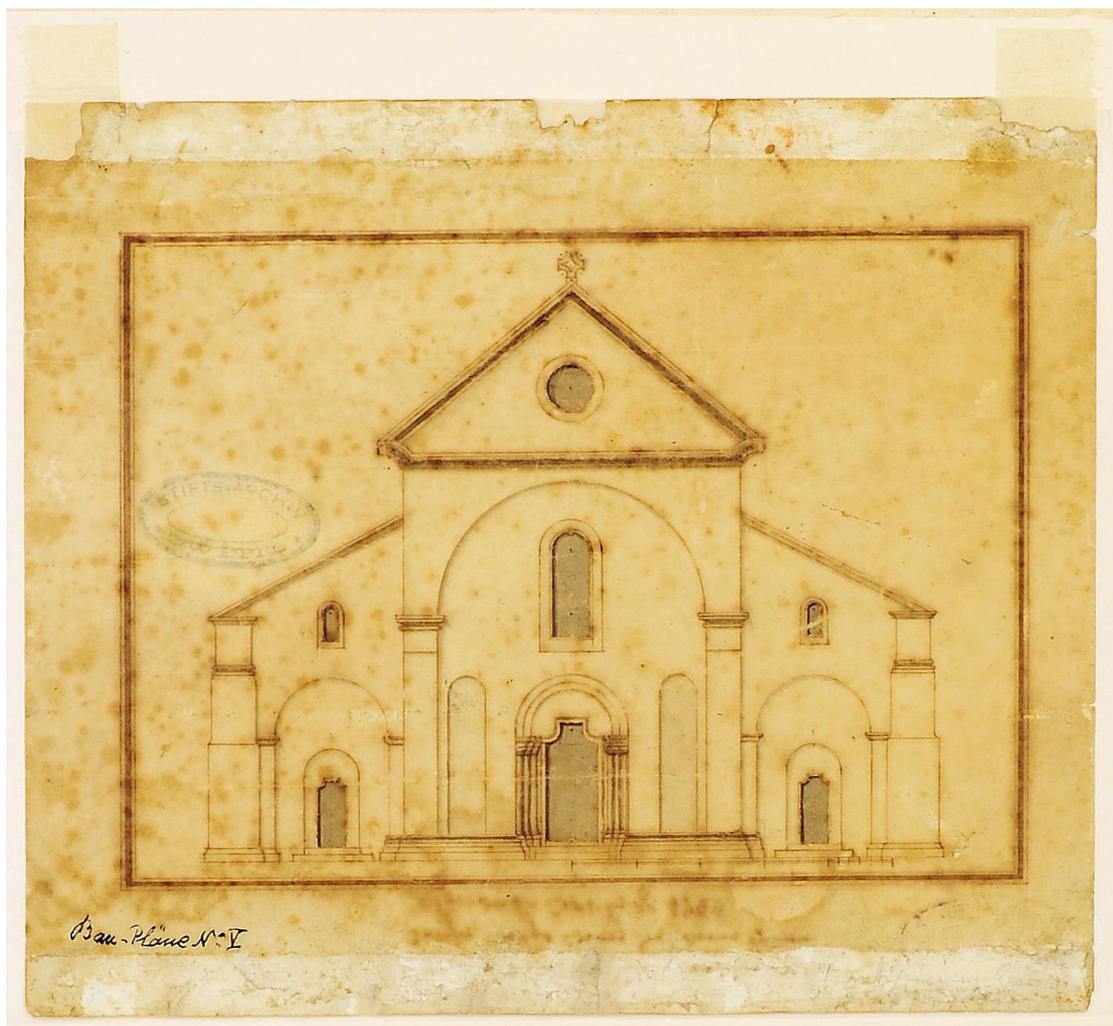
Stiftskirche Zwettl, romanesche Kirchenfassade, Rekonstruktion der Westfassade, vor 1722, StiAZ Plansammlung V.
